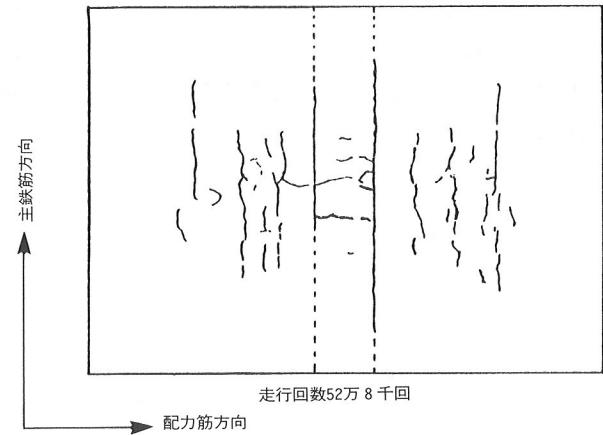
DLR供試体ひび割れ状況(床版下面)
